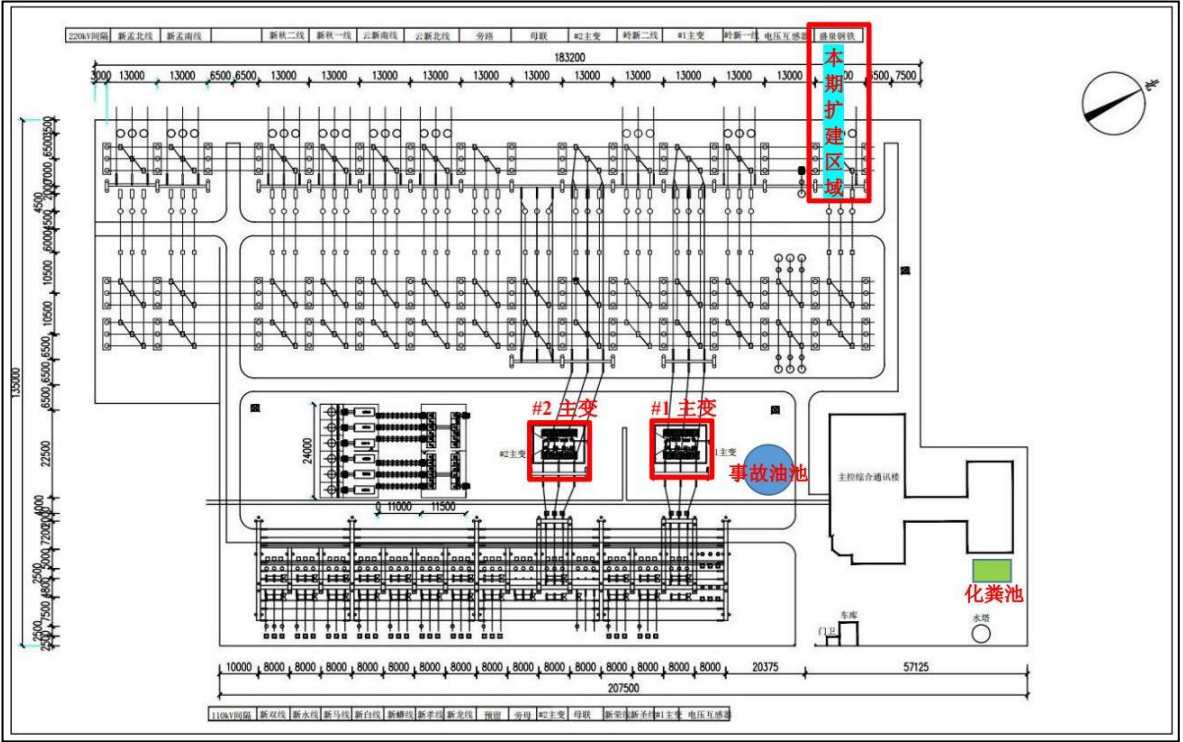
新市 220kV 变电站总平面布置图及本期间隔扩建布置图
